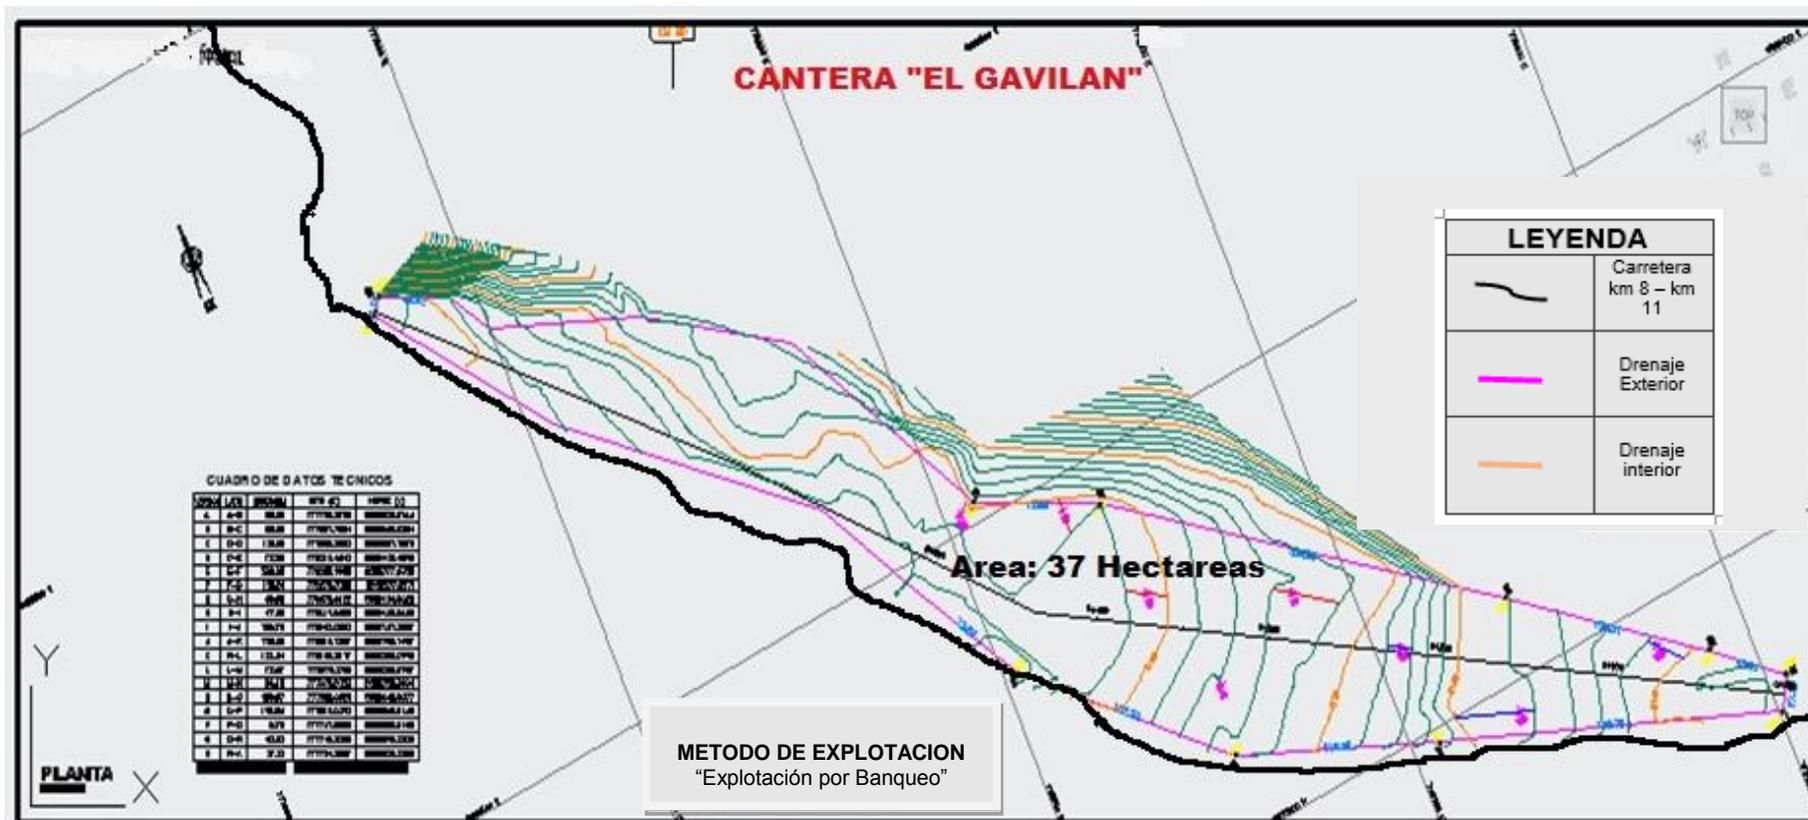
Plano de drenaje de la Cantera El Gavilán.
